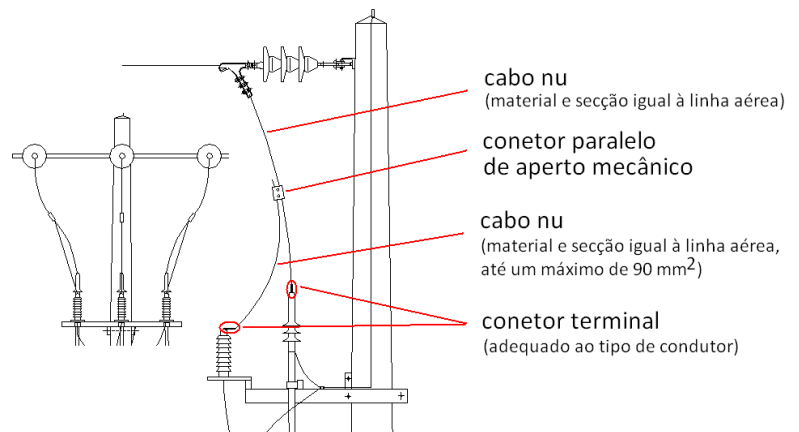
Ligação à linha aérea em instalações sem seccionador.
